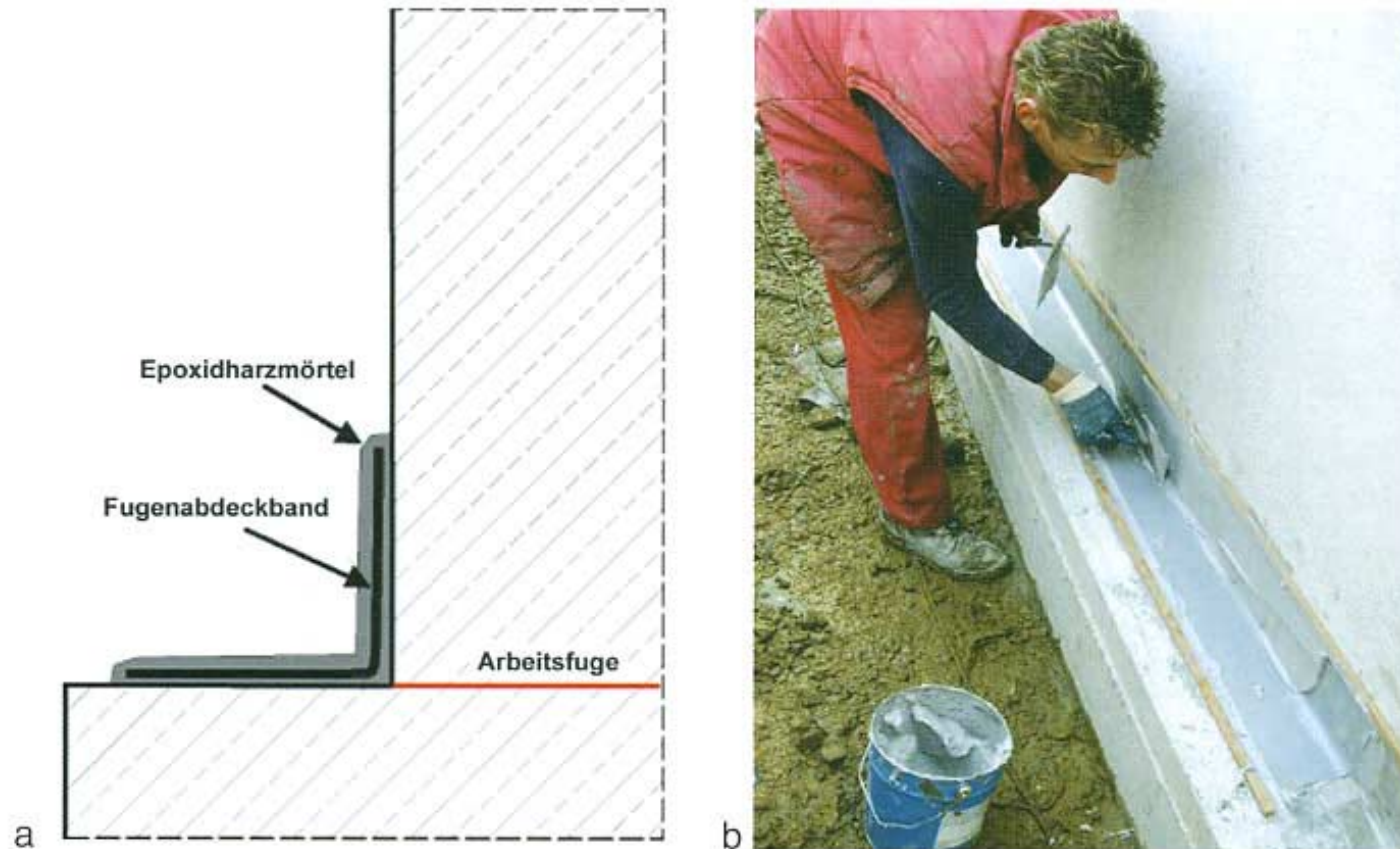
Abdichtung einer Arbeitsfuge mit einer streifenförmigen Fugenabdichtung
